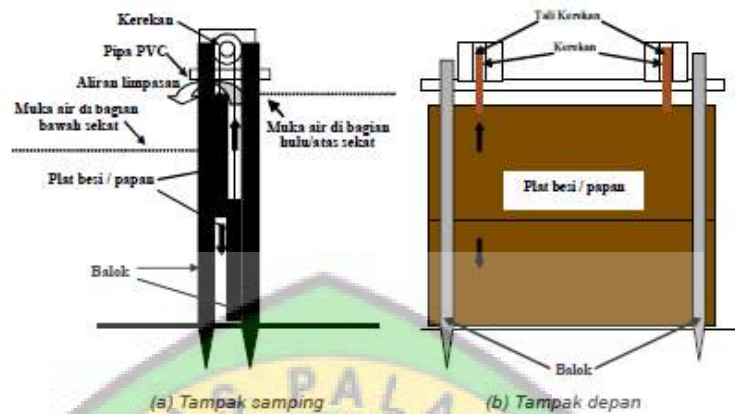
Sekat dari Bahan Papan Plastik
